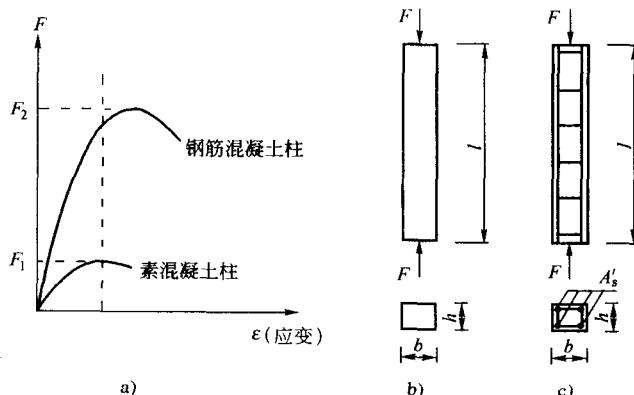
素混凝土和钢筋混凝土轴心受压构件的受力性能比较
